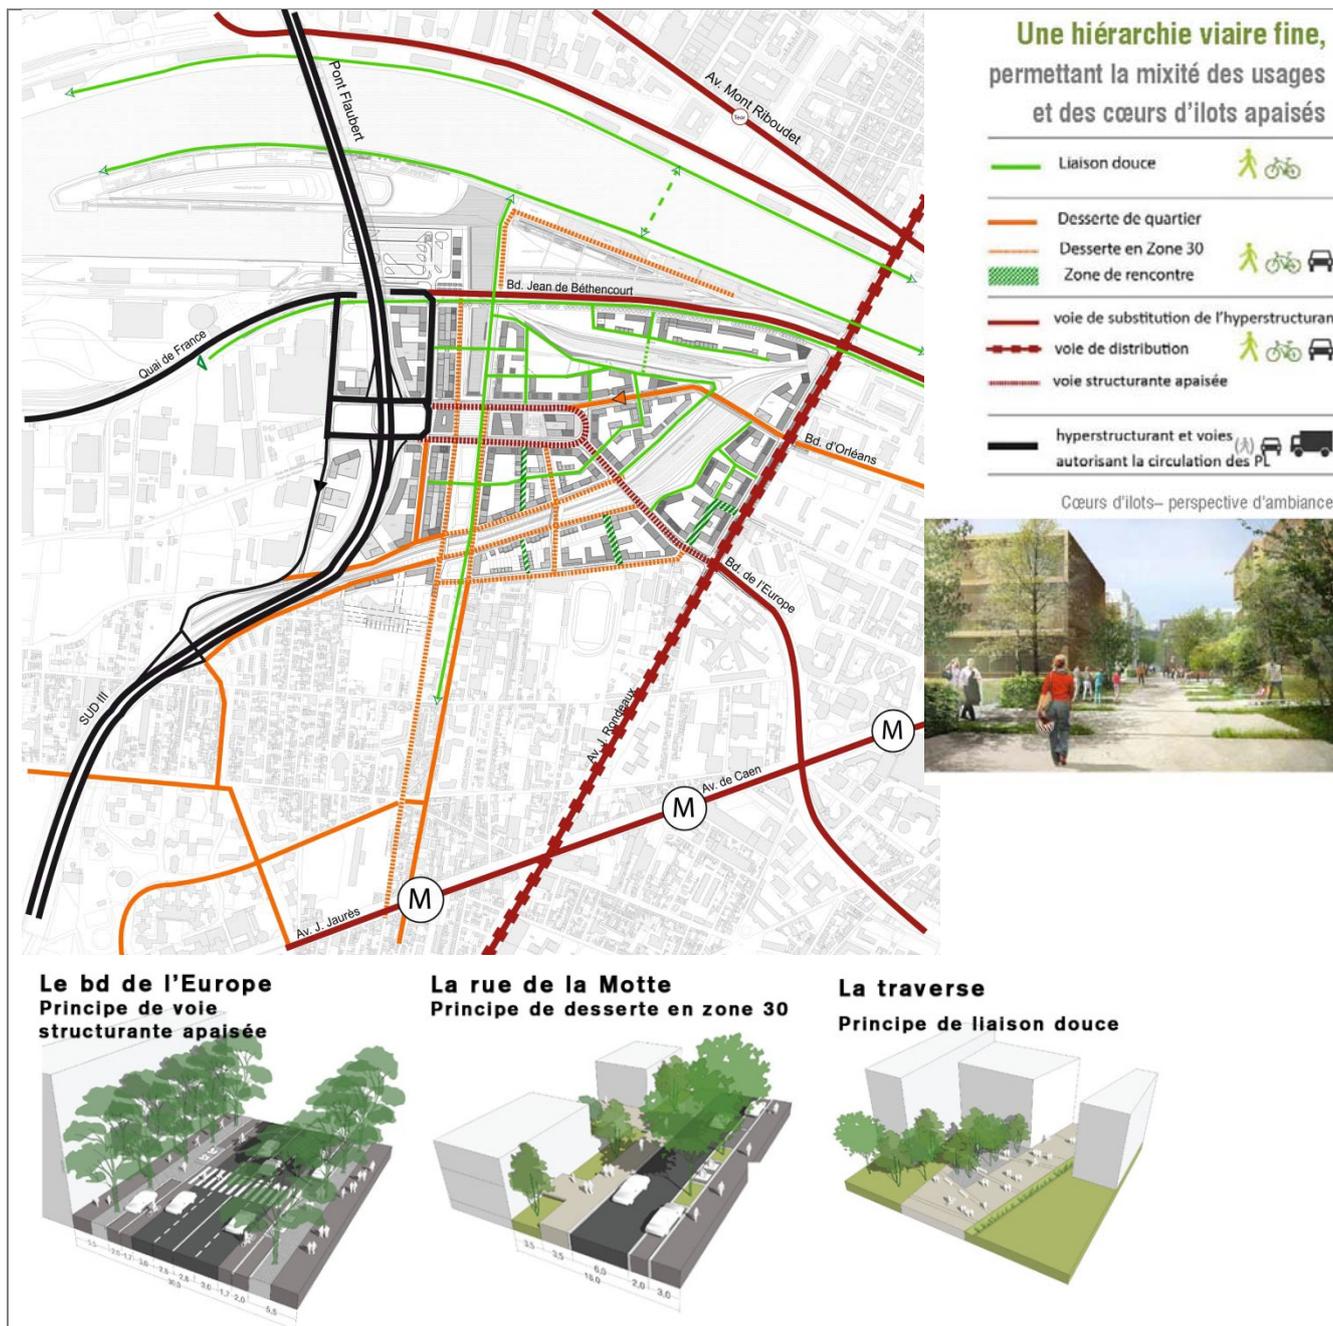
Plan du réseau viaire sur plan masse indicatif [MOE urbaine, 2015]
